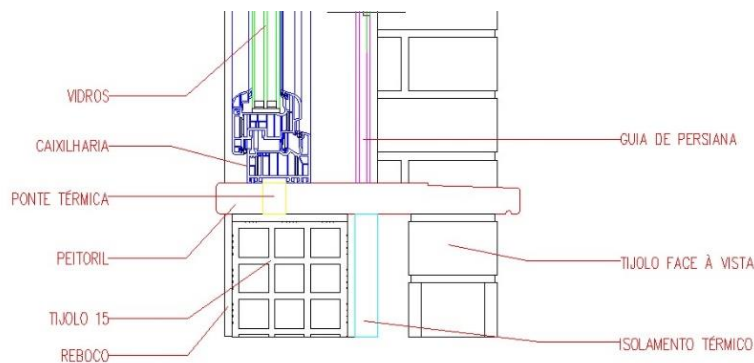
Corte de zona de vão, com peitoril bem dimensionado [17]
